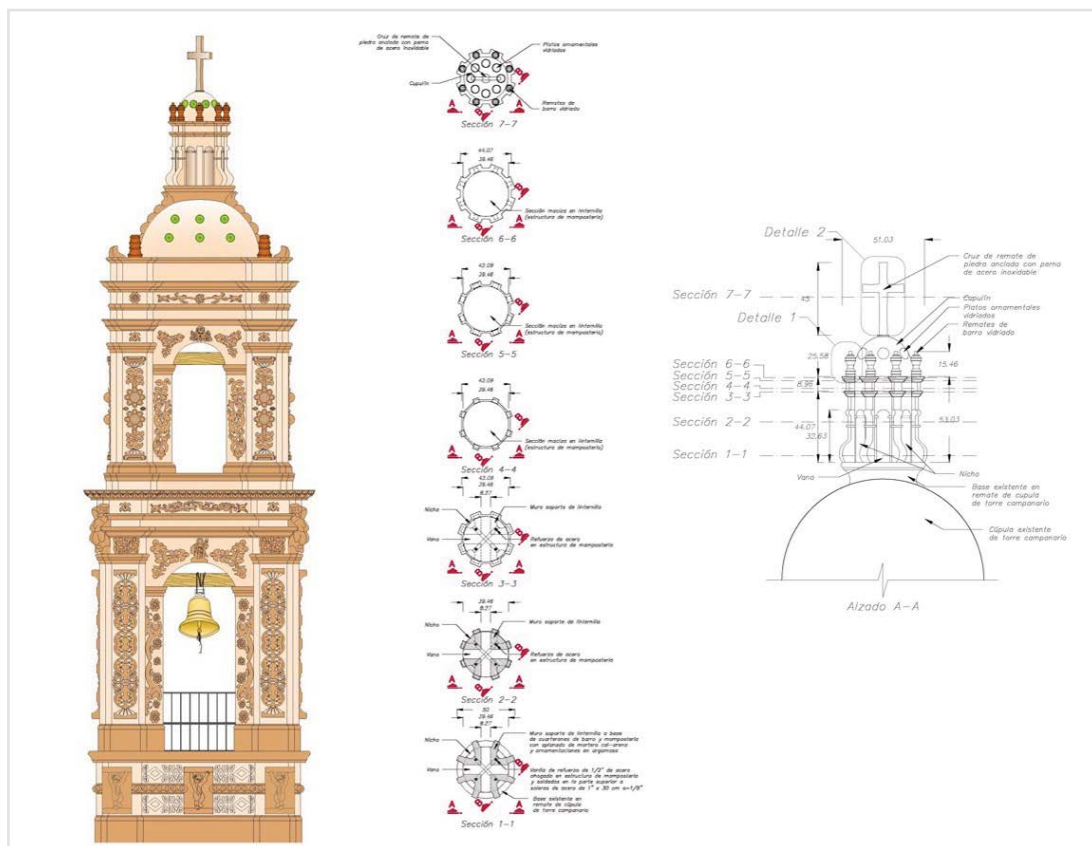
Dibujo elaborado en AutoCAD del campanario en base a los levantamientos arquitectónicos. Imagen de autor.
